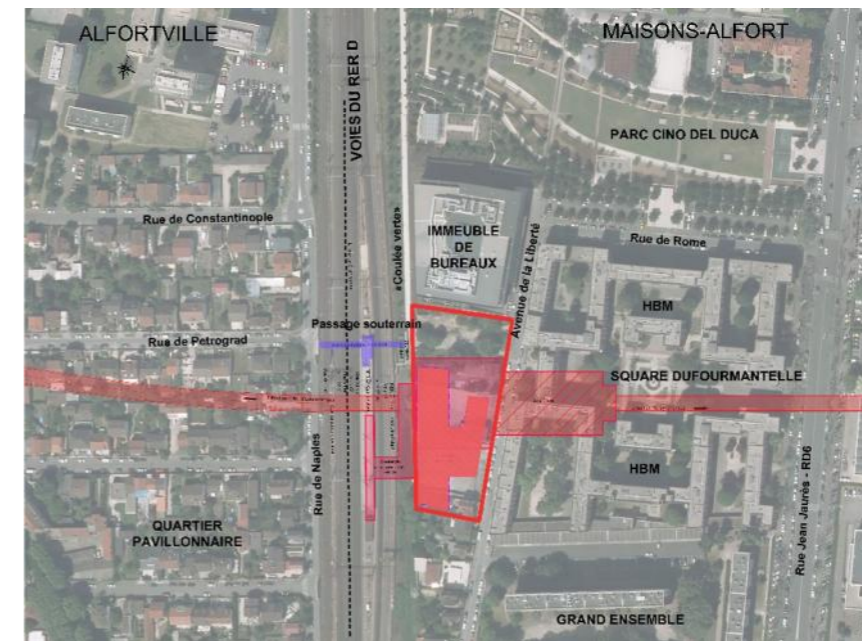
Plan masse 1/1000ème - VPA. 23/12/2014
